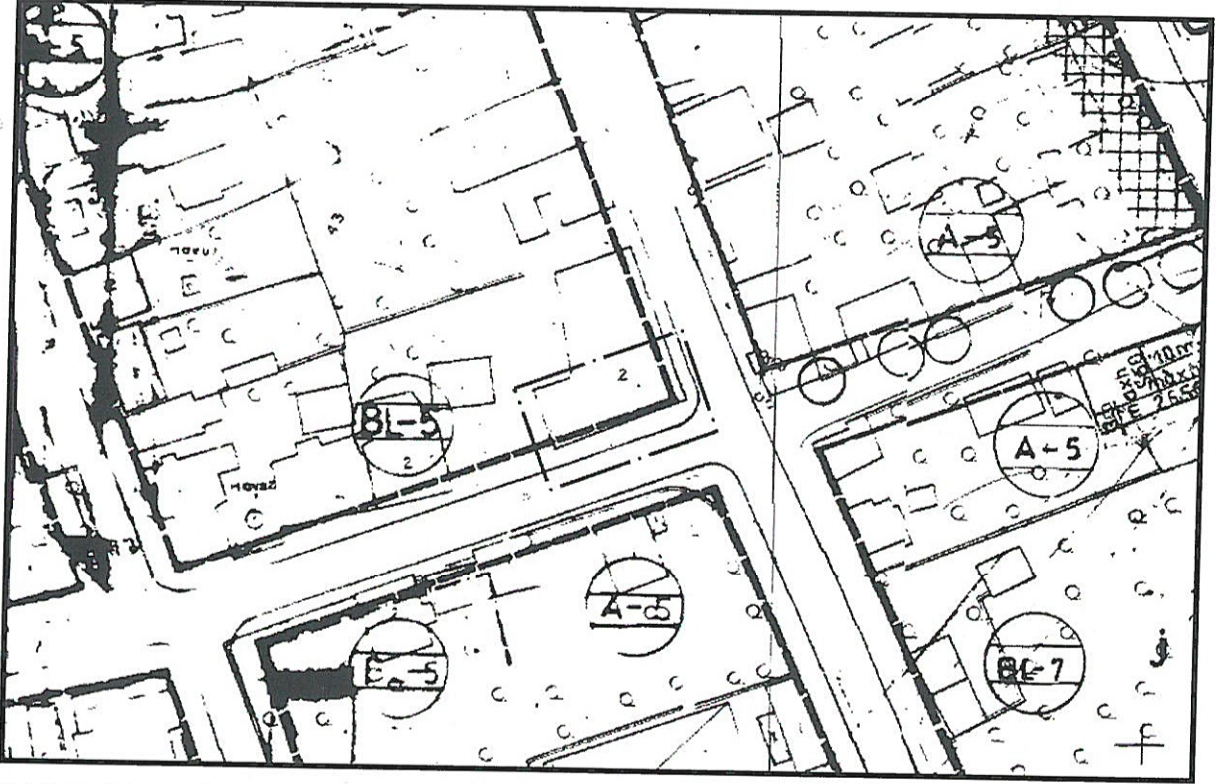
31.5.1966 tarihli onaylanan vaziyet planı
